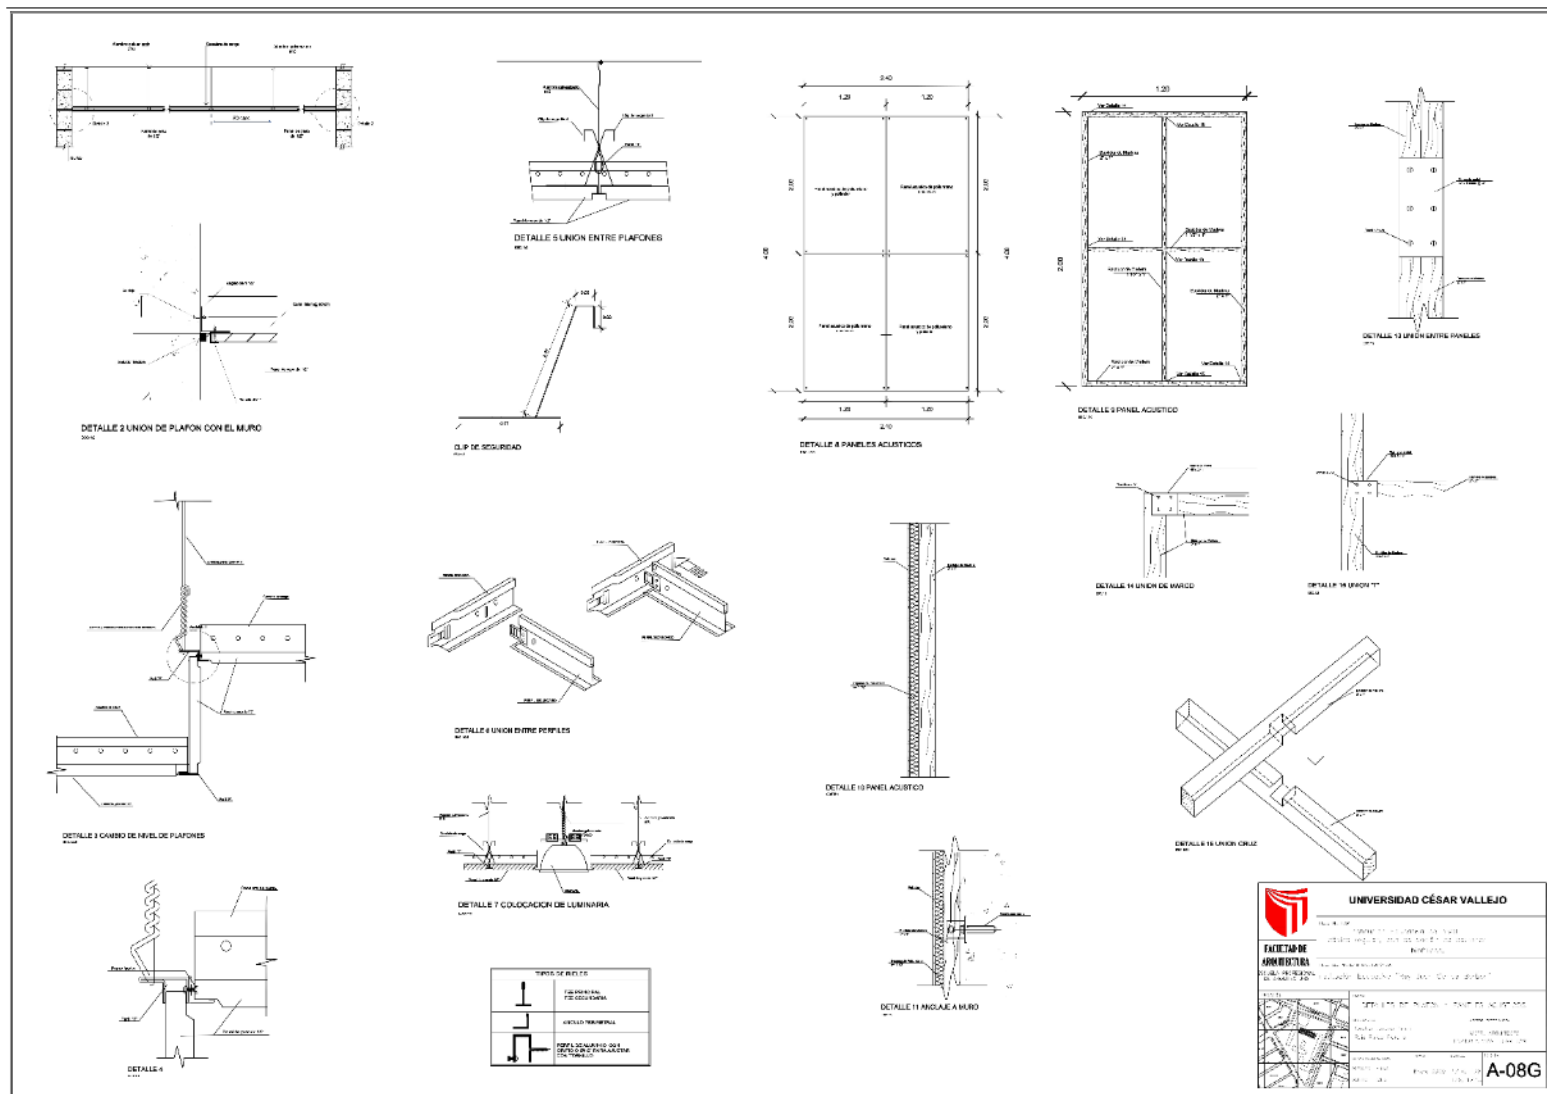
Plano Detalles de plafón y paneles acústicos bloque “G”, Fuente: elaboración propia
